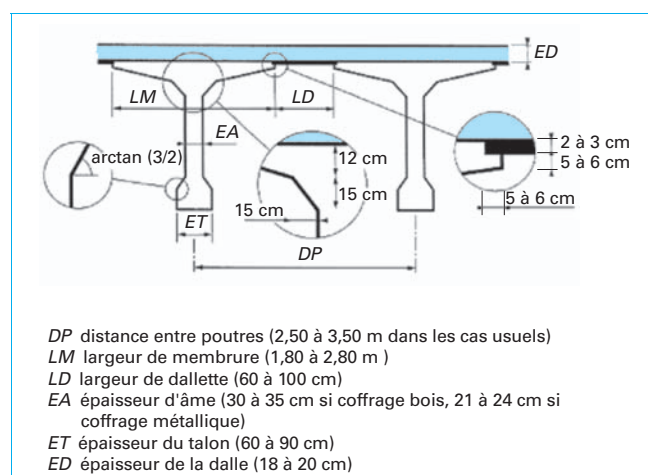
Dimensionnement des ponts à poutres en béton précontraint par post-tension
